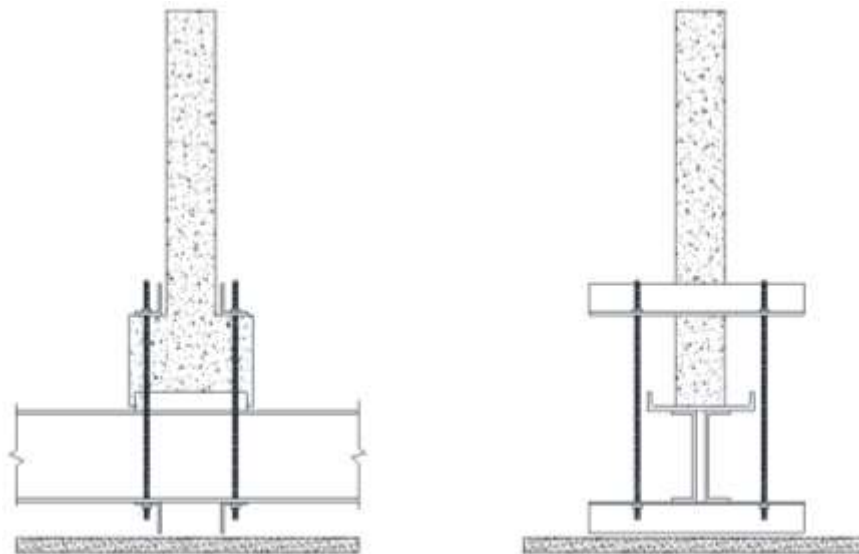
Sistema de empotramiento de los elementos estructurales (Autores)
